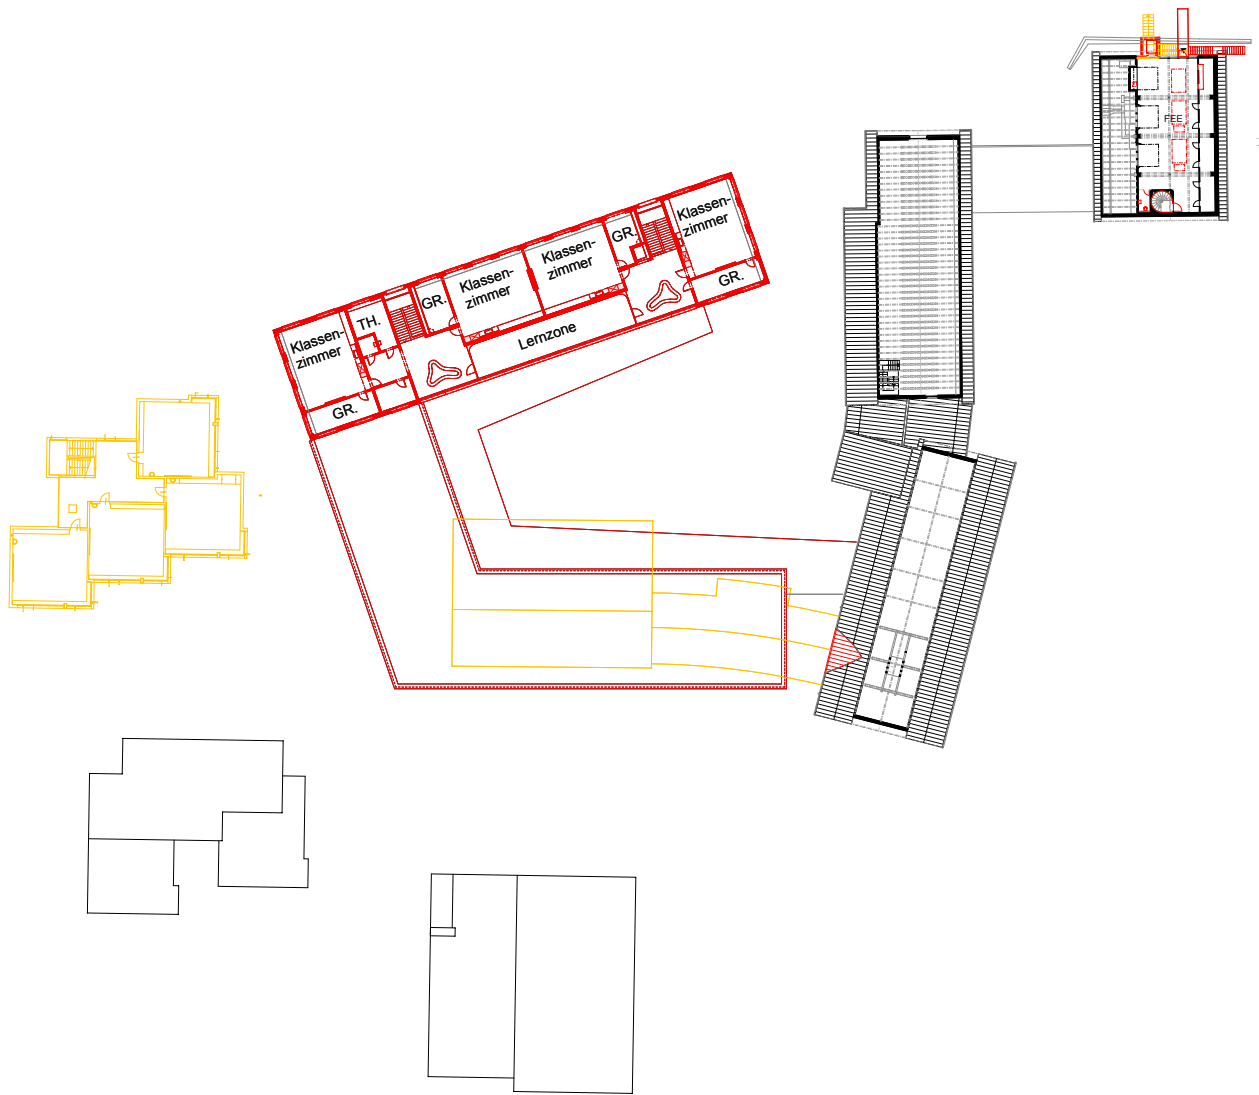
2. Obergeschoss: Gebäude A und (Planstand Bauprojekt 2014)
